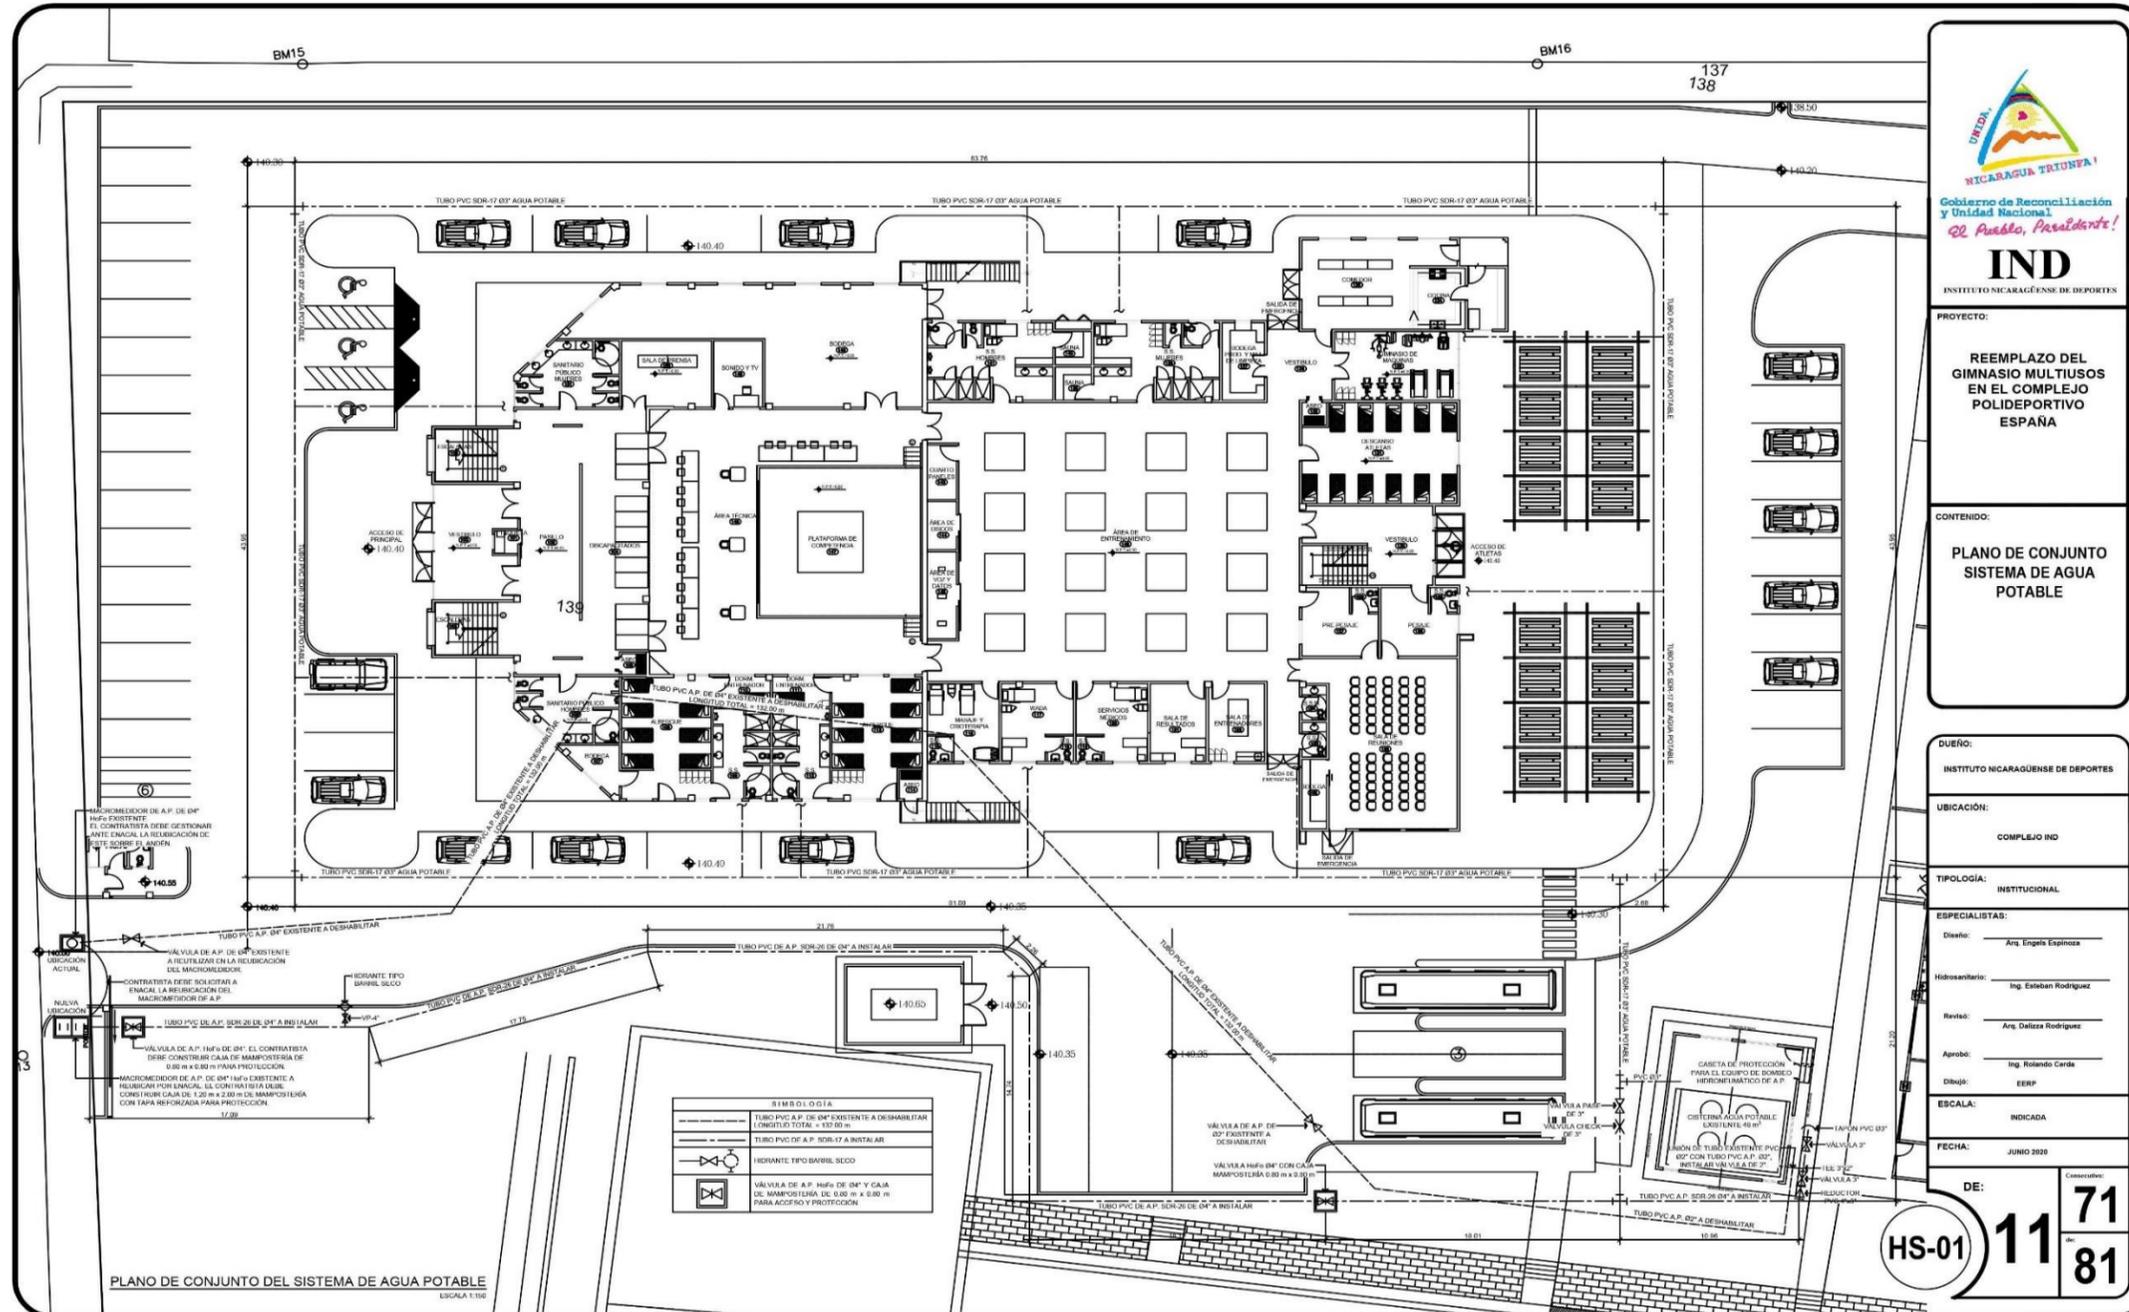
Plano de conjunto del sistema de agua potable, modificado por la Practicante Fuente: Báez, J. (2021) Supervisión: Ing. Miguel Berrios
